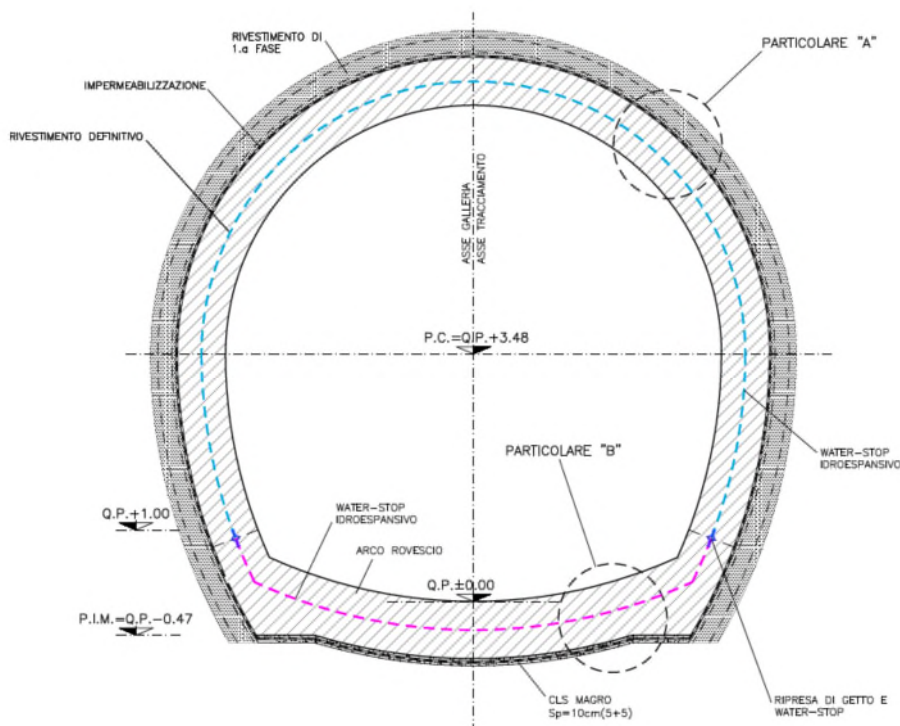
Impermeabilizzazione e drenaggio Tipo 3
